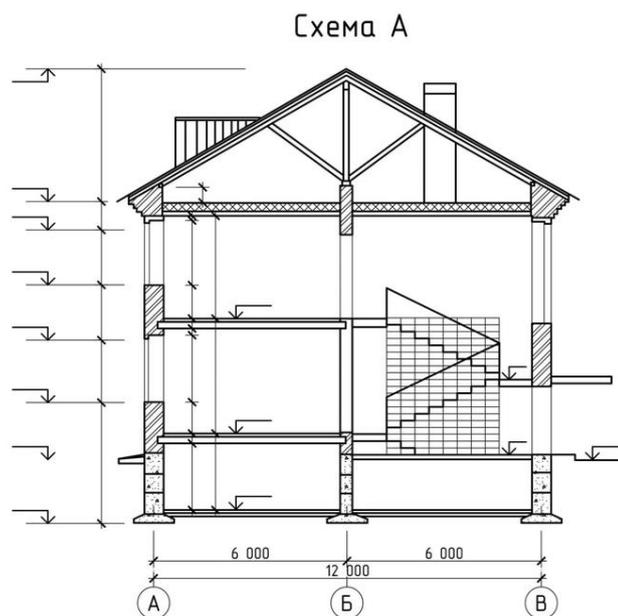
схема А: поперечный разрез здания со скатной стропильной крышей по лестничной клетке
